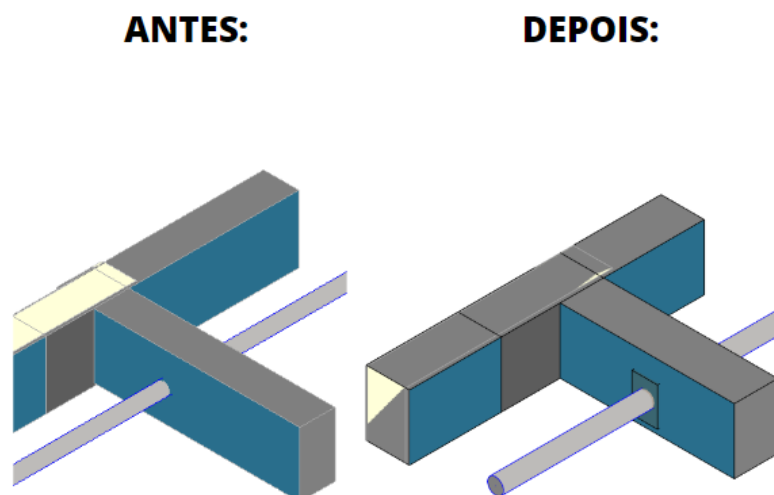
Conflito tubulação com viga (Pavimento 1)
